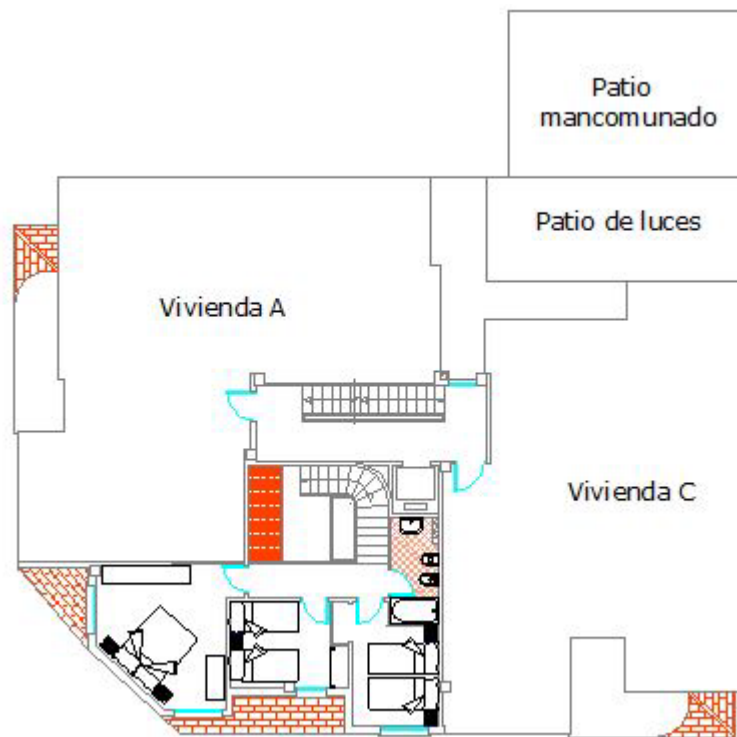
Distribución plantas 2ª, 4ª, 6ª [Anexo II. Planos]
